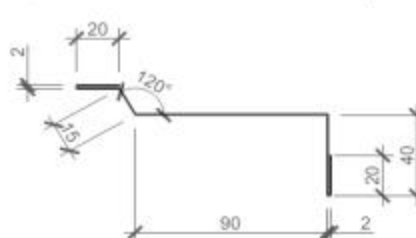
Angle rentrant – Pose verticale (avec fixations cachées en extrémité)
